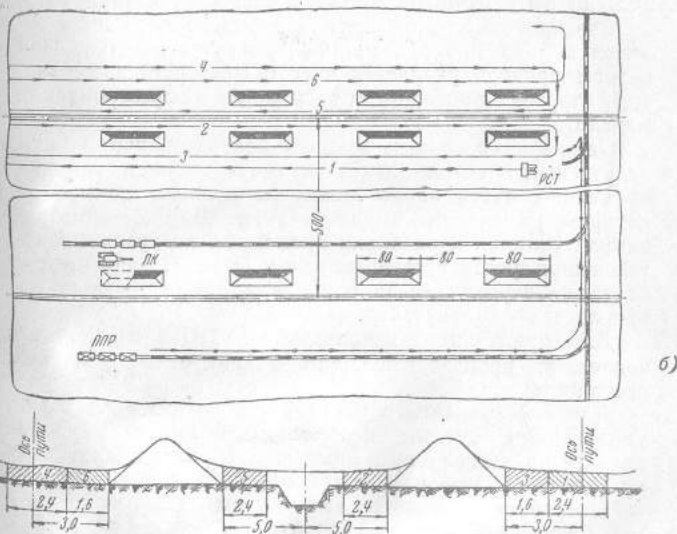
для вывозки фрезерного торфа, убранного машинами ФПУ или УПФ; б—работа для вывозки фрезерного торфа, убранного машинами БПФ или УМПФ.
